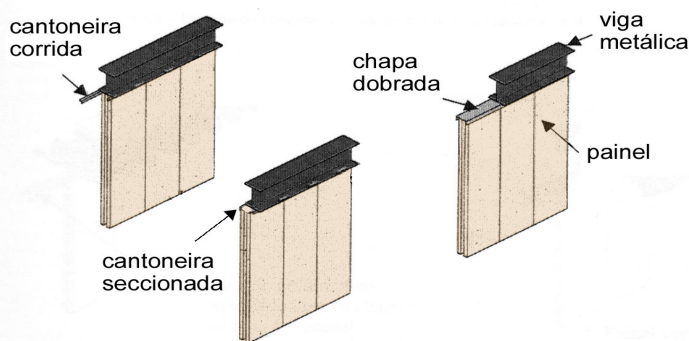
Encontro dos painéis com o flange inferior da viga, através de cantoneiras e chapas dobradas. (SICAL, 1999)
